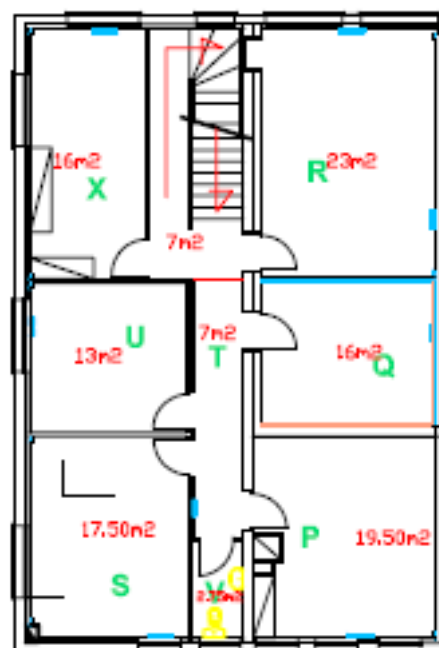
PLAN DU SOUS-SOL -1
